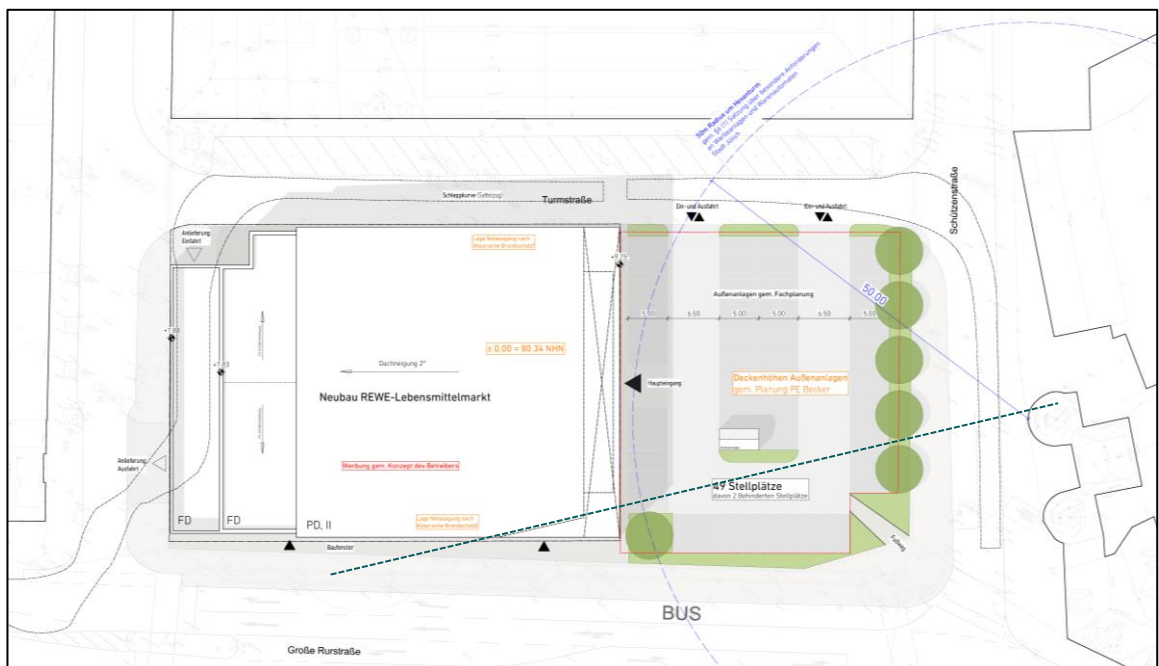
Lageplan des Vorhabens mit Kennzeichnung der Sichtachse zum Hexenturm; Quelle: Gronau plan GbR.
